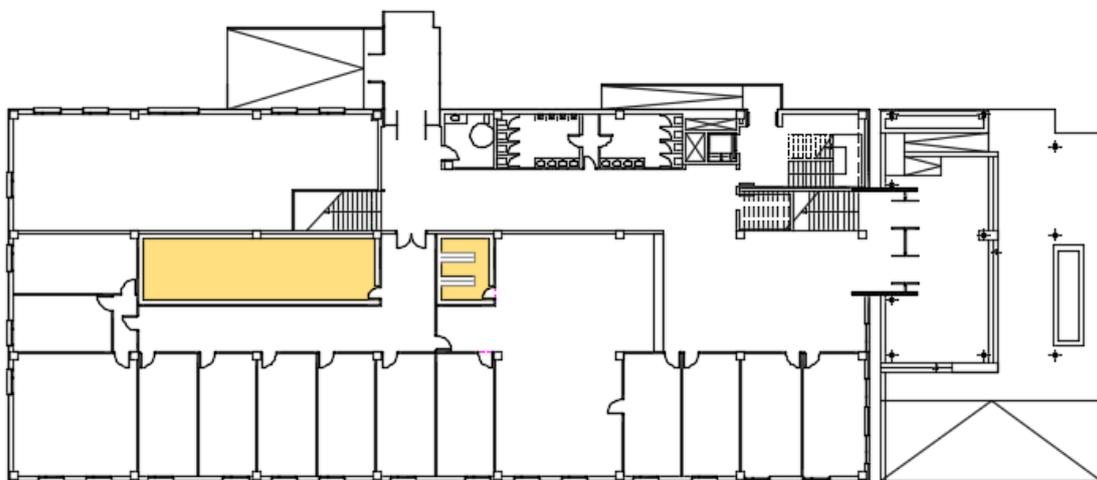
Situación de Archivos en Planta Baja. Figura extraída del plano 52.
